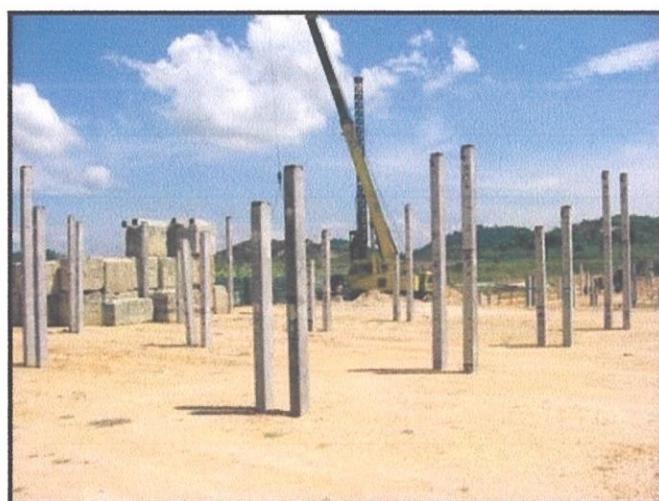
Sarung Cerucuk Tuang Di-Situ
